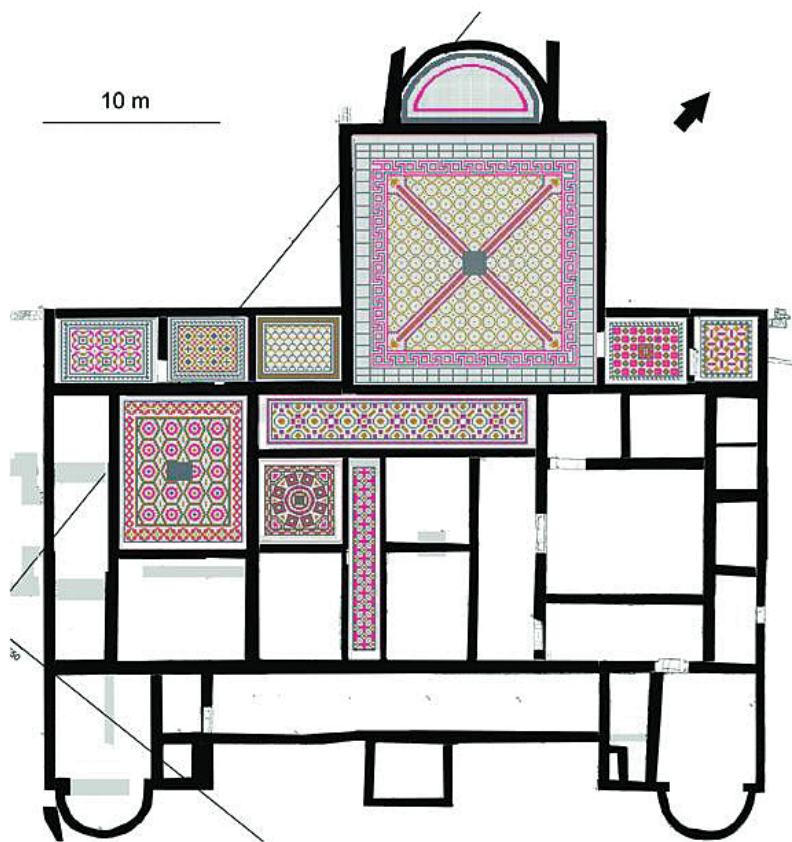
Villa di Bruckneudorf: planimetria del nucleo principale (da Zabehlicky).
